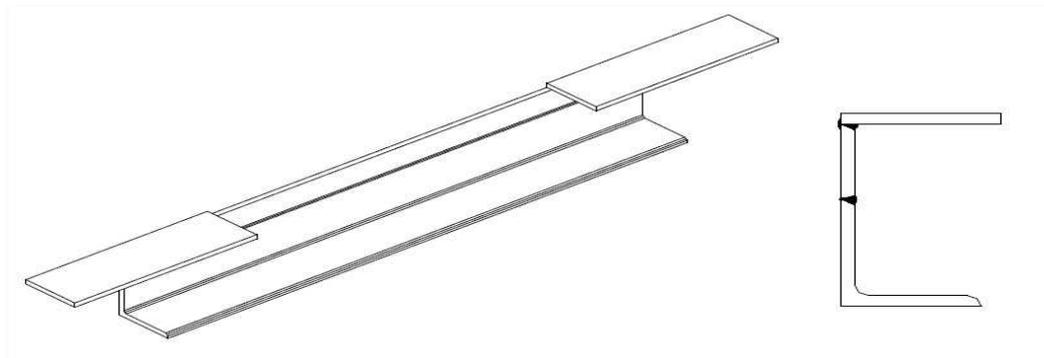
Perfil metálico para apoio de lajes alveolares (MELO, 2004)
